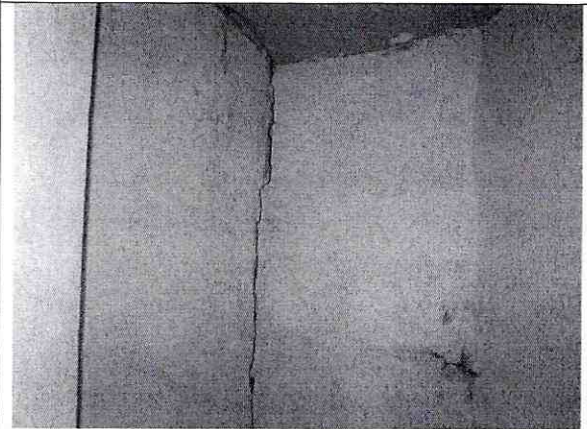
Agrietamiento en cara interna del muro de fachada.
